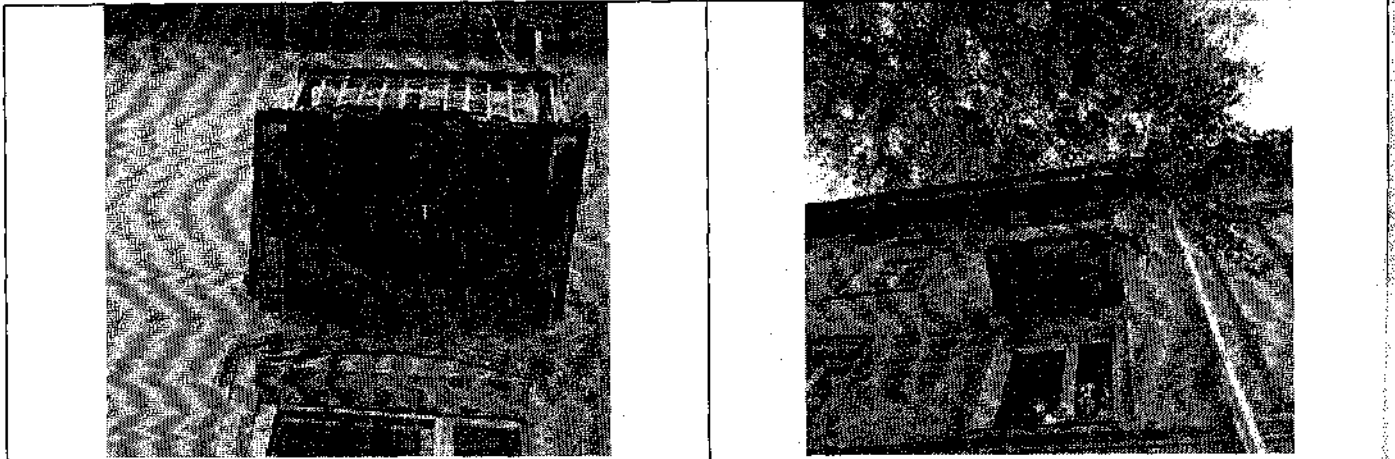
, 2. Значительные дефекты и повреждения консольных железобетонных плит балконов.
